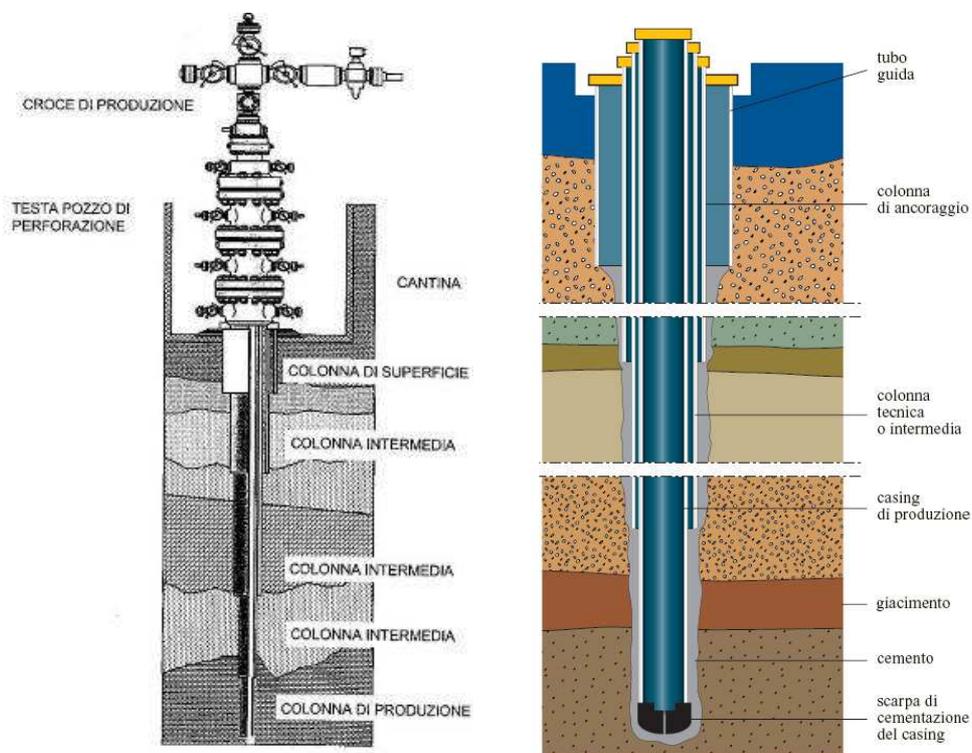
Schema di sistema telescopico di tubaggio e di rivestimento del pozzo.
